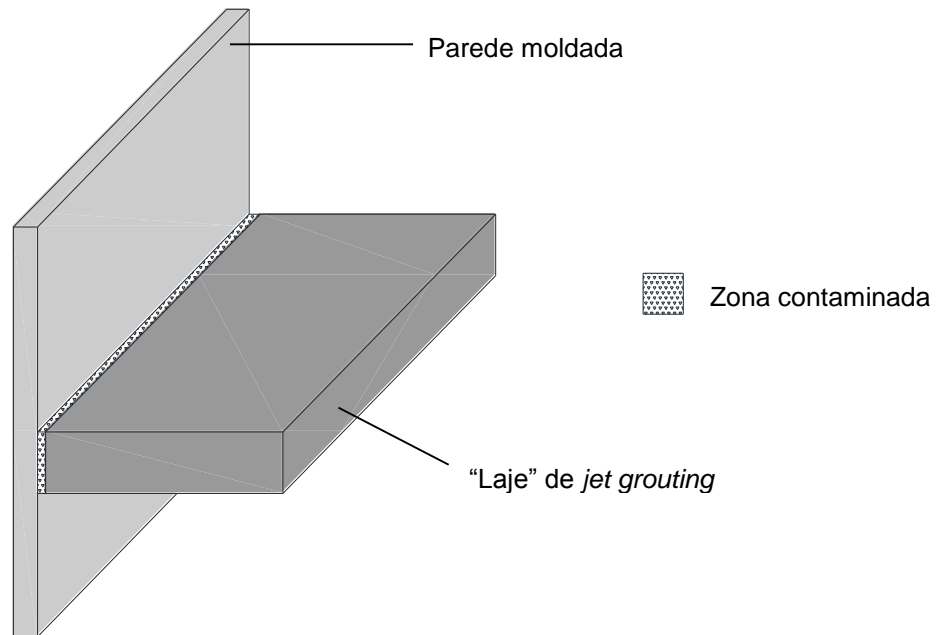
Efeito da contaminação entre a parede moldada e a "laje" de jet grouting.
